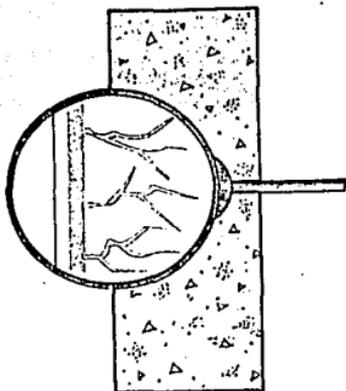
Impermeabilizantes integrales. Obturación de poros y capilaridades
